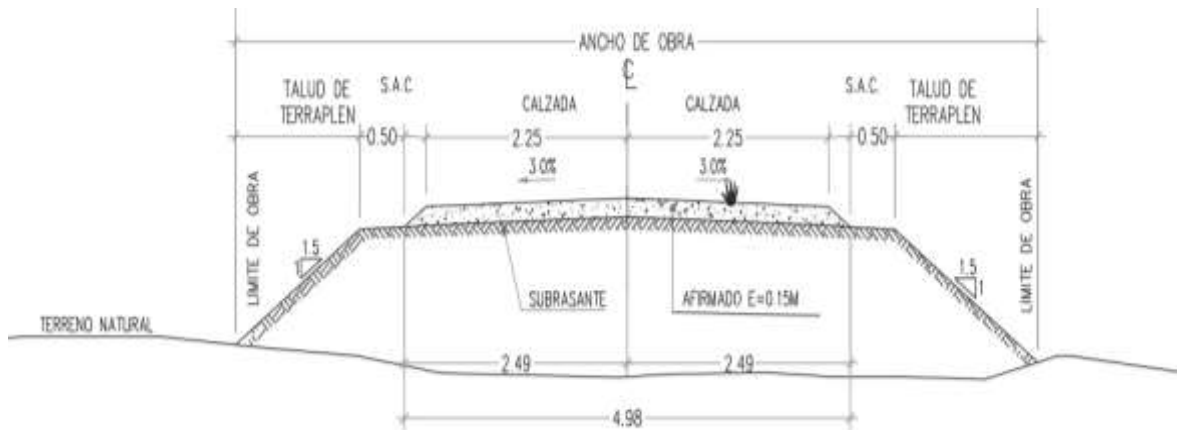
Sección típica en relleno. Fuente: Plano de secciones típicas.
